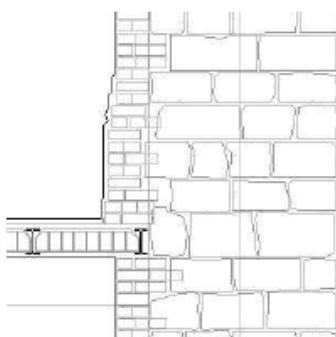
Contrafuerte y muro. Buttress and wall.
